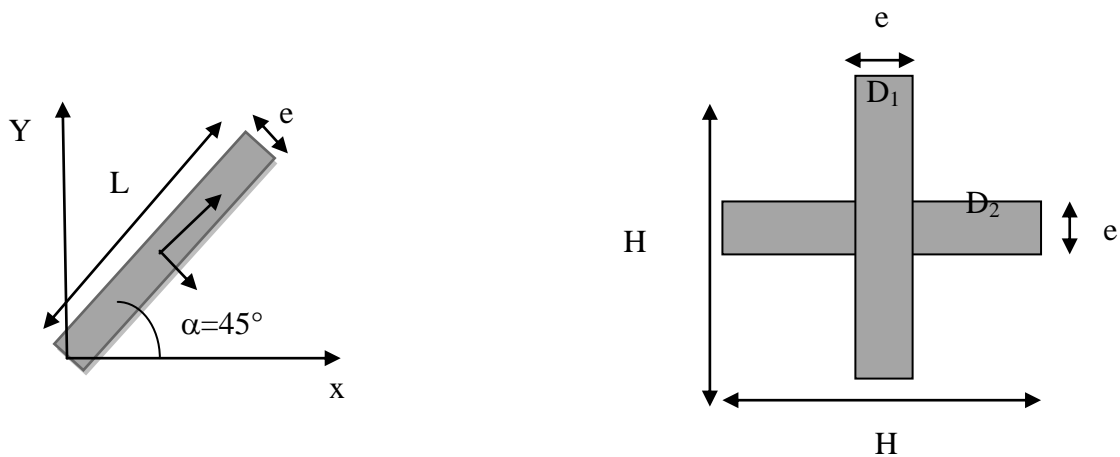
Coupe sur des voiles pleines inclinées.
